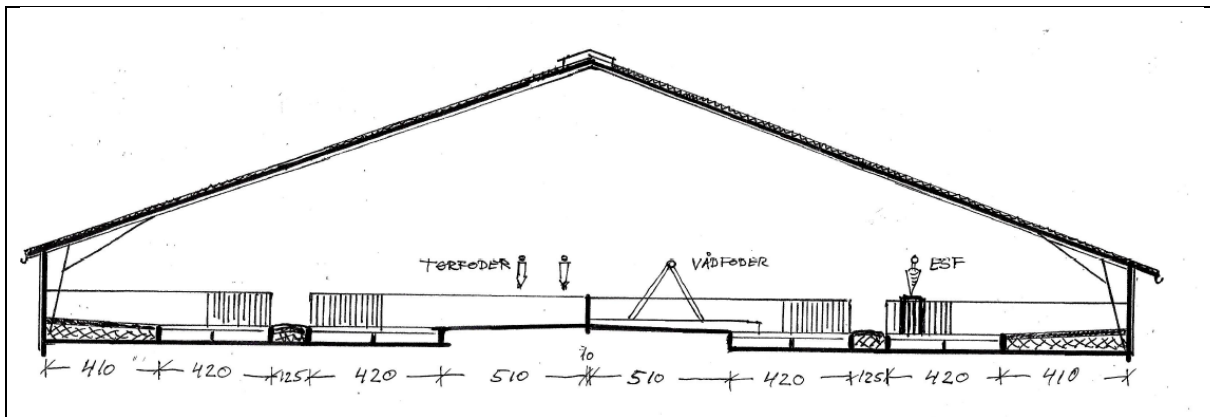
Indretning med gulvfodring. Hver so bør have fri adgang til 1,3 m<sup>2</sup> ædeplads. Areal med spaltegulv/drænet gulv skal tilpasses jf. lovkrav. Sygestierne er i dette eksempel placeret mellem to drægtighedsstier
